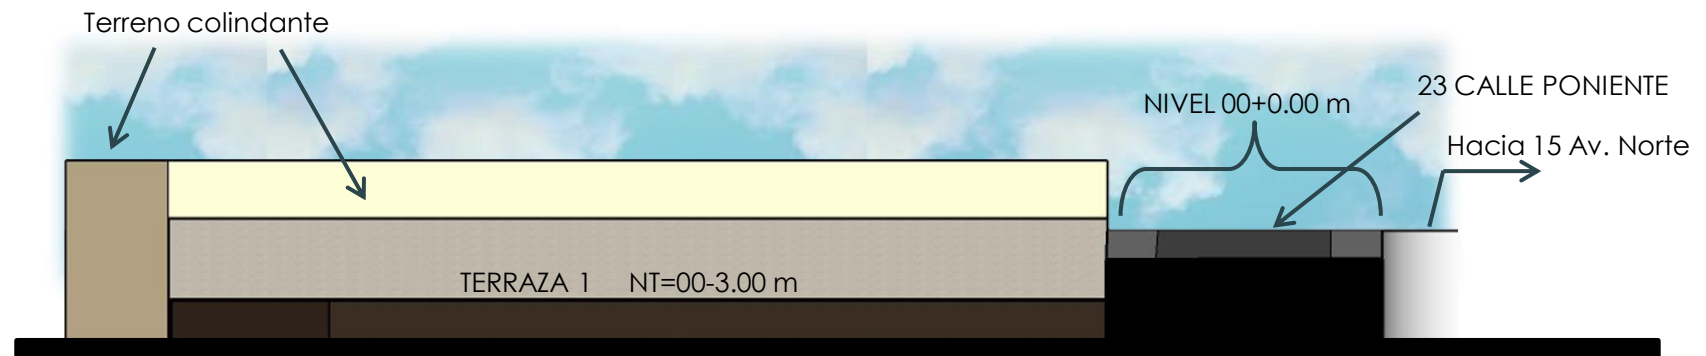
VISTA AL ESTE Sección transversal, terraza 1. Elaboración propia
